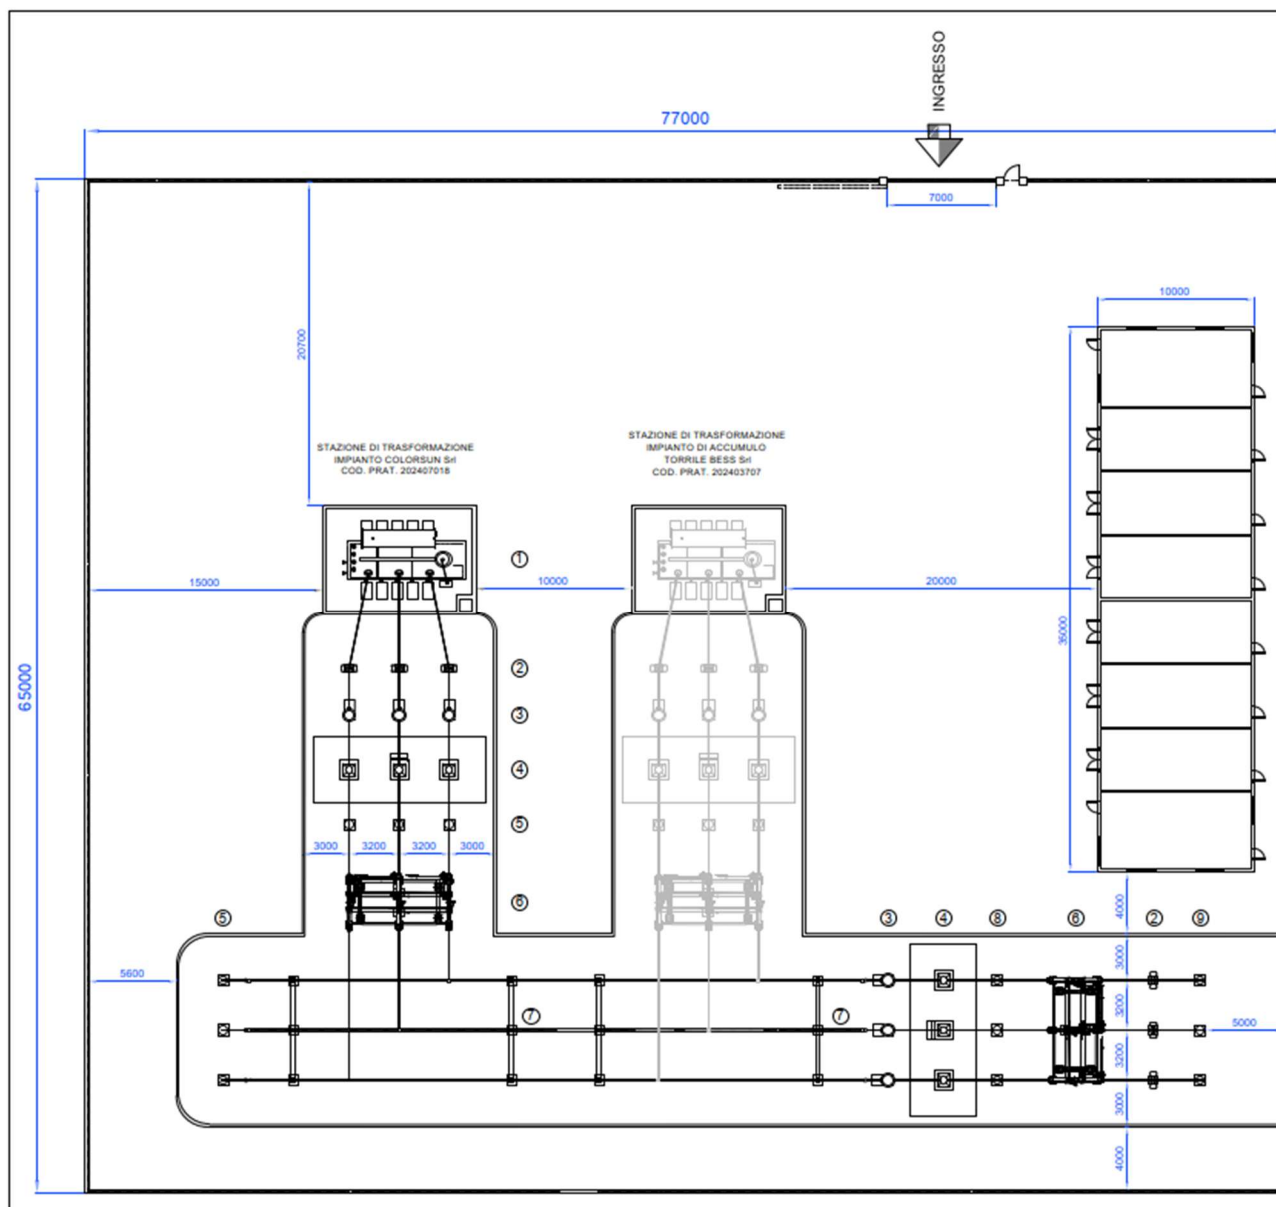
Planimetria elettromeccanica Stazione Elettrica Condivisa
